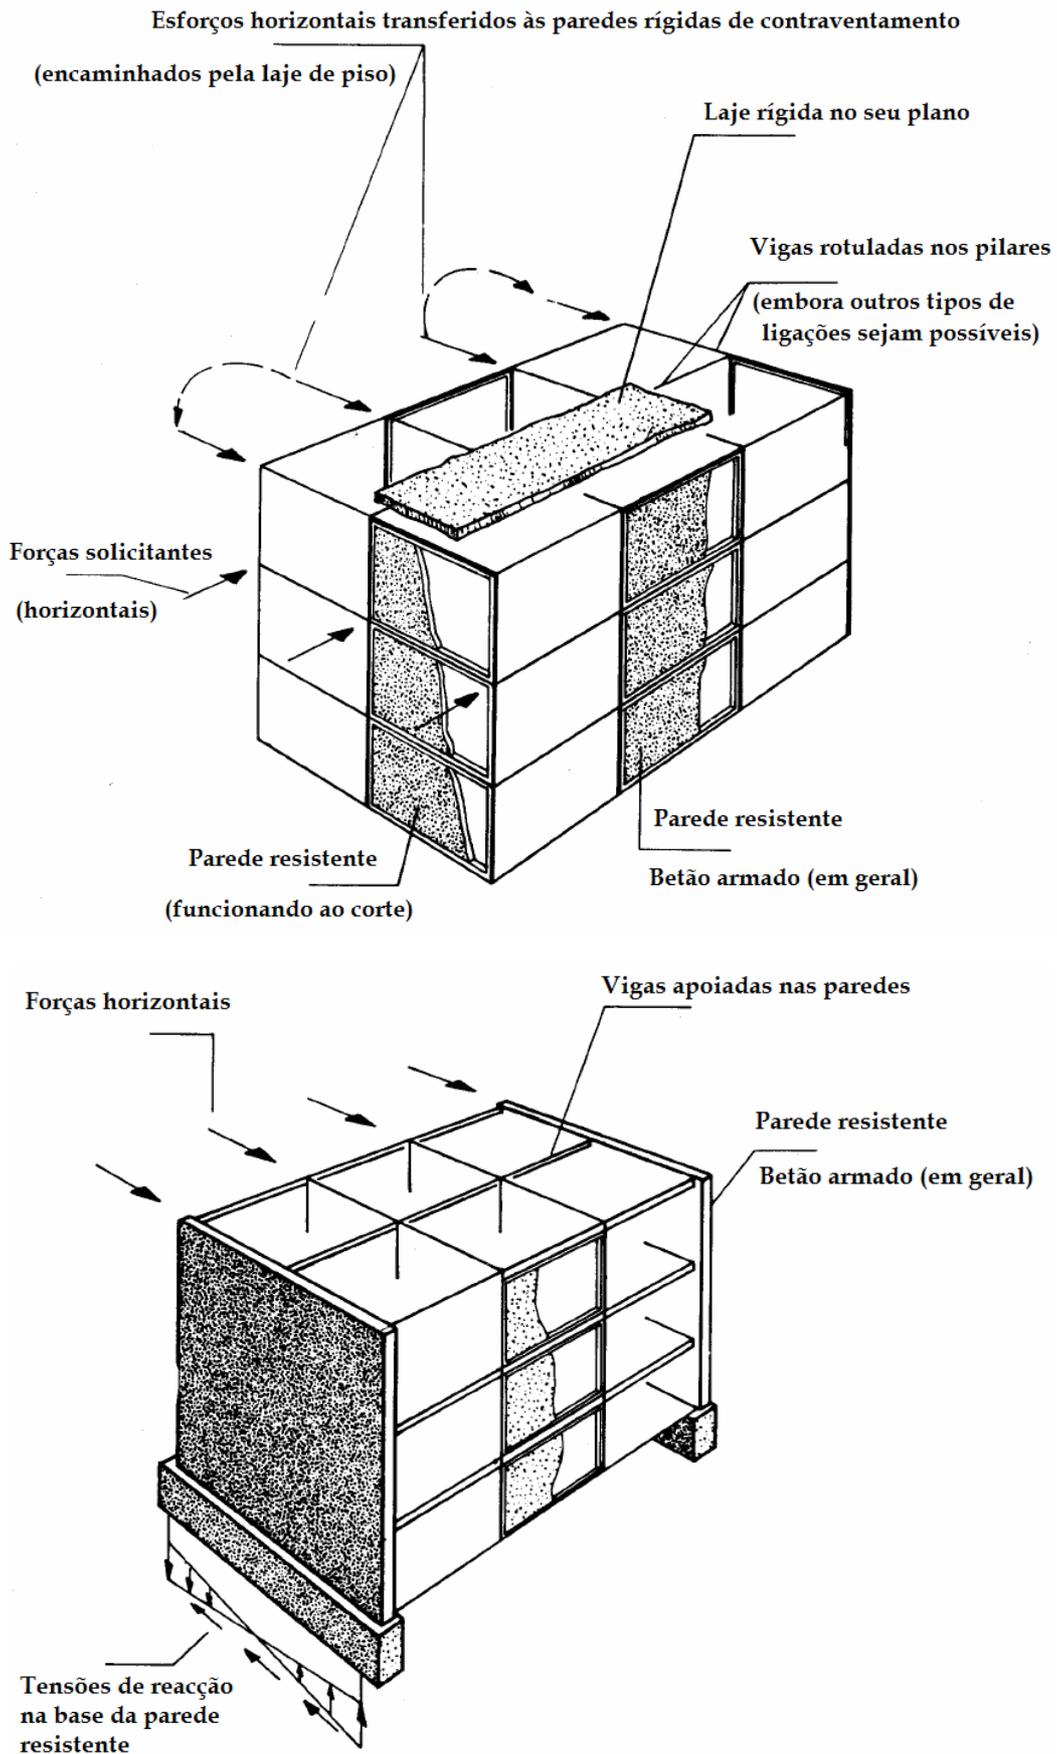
Estrutura com parede de contravento ao corte [22]
